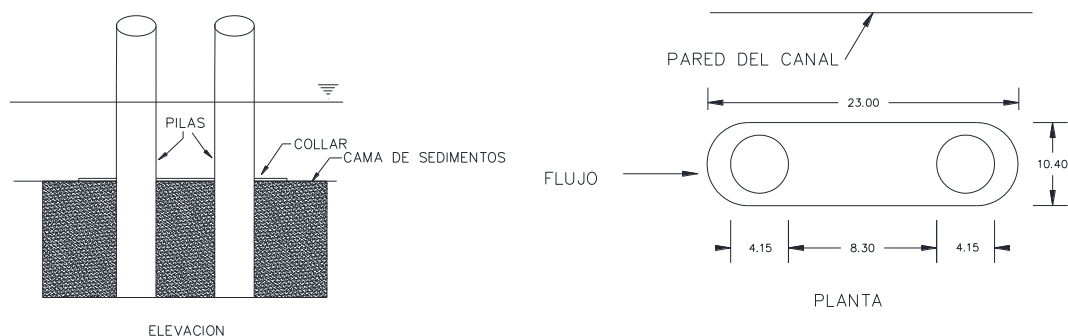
Arreglo del grupo de pilas con collar en el canal artificial. Muee, B. (2008).
